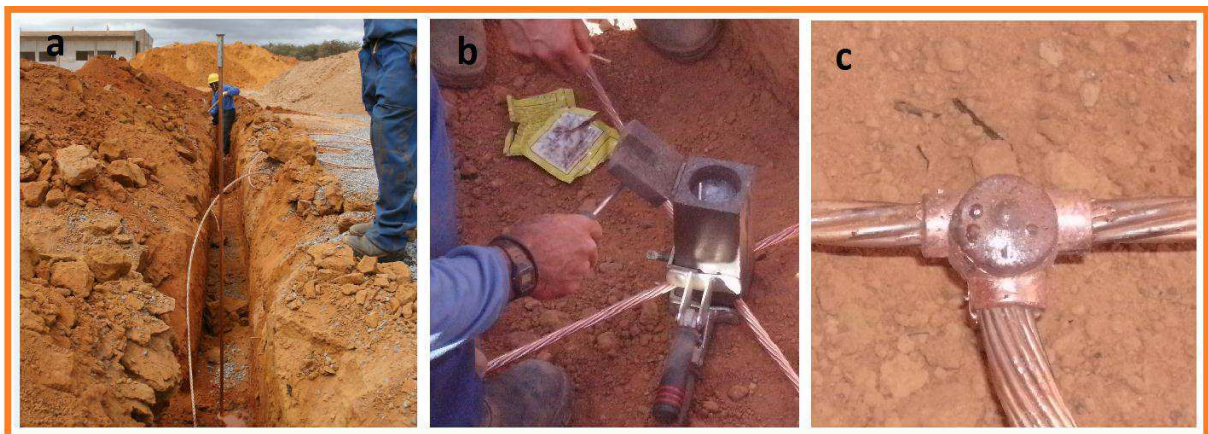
Malha de Terra: (a) lançamento de cabos e hastes (b) molde para solda (c) solda exotérmica
